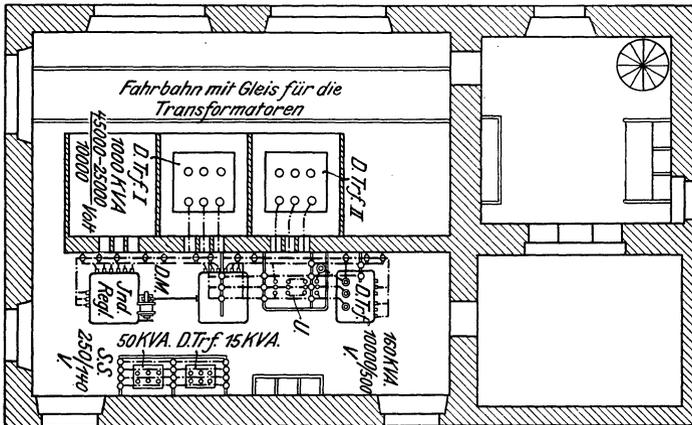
Grundriß des Erdgeschosses im Hauptgebäude.
